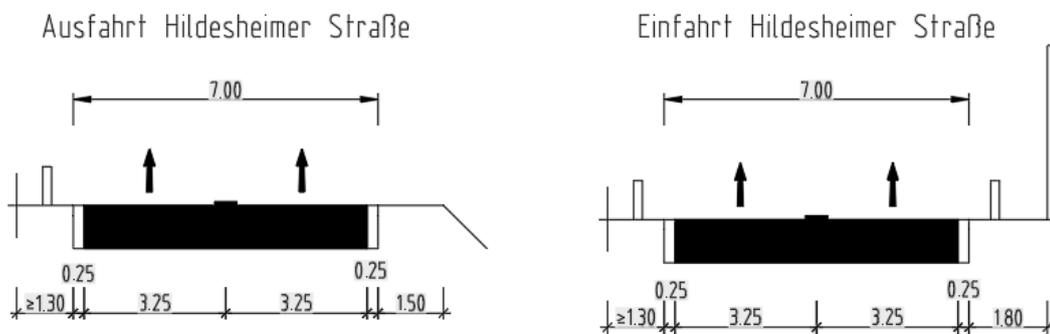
Rampenquerschnitt RRQ 2 Hildesheimer Straße
